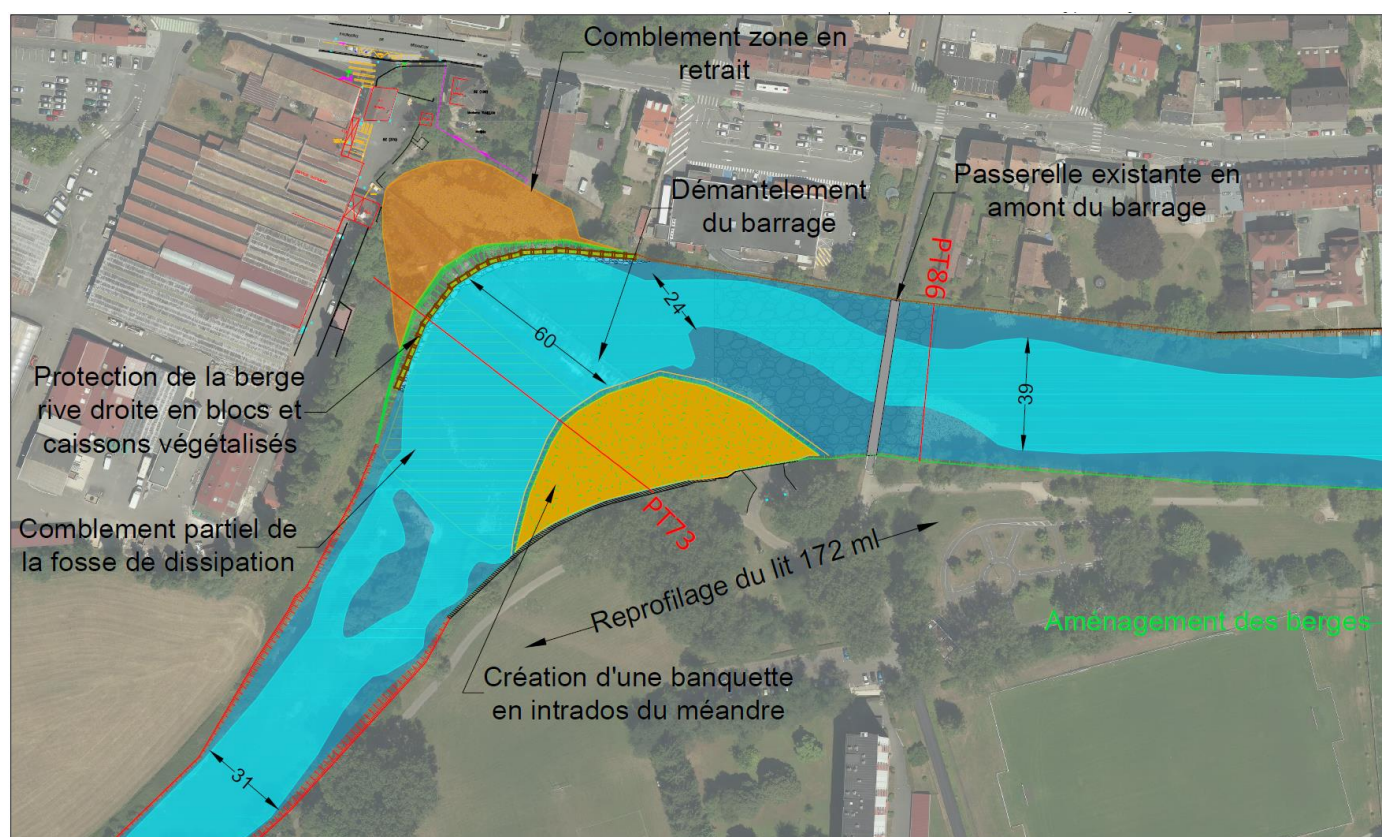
Plan de masse au droit du barrage (scénario RCE1)
